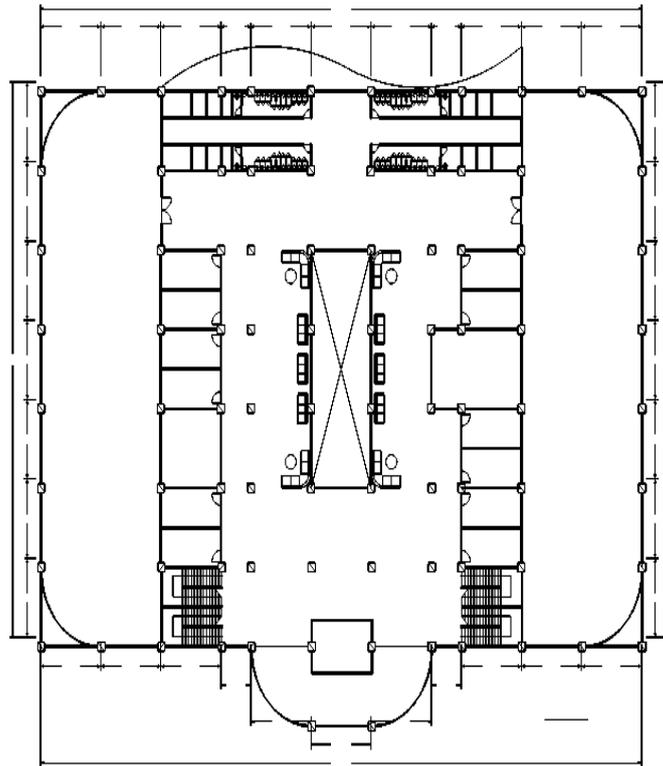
Denah Lantai 3 Hasil *Redesign
